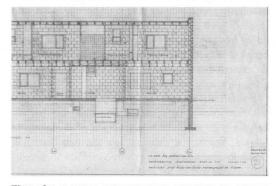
Sección longitudinal constructiva de la casa parroquial (© Aldo van Eyck Archive)
